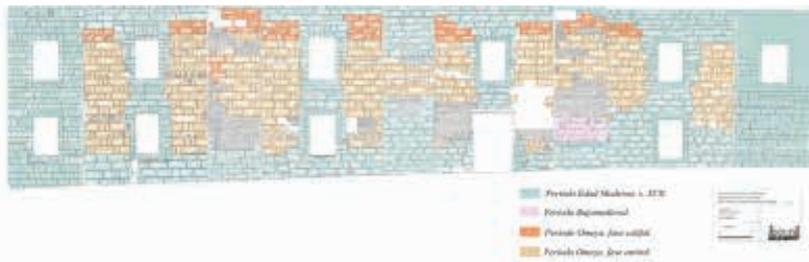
Fuente: Pedro Marfil; Alzado de la fachada oriental con lectura de paramentos-
